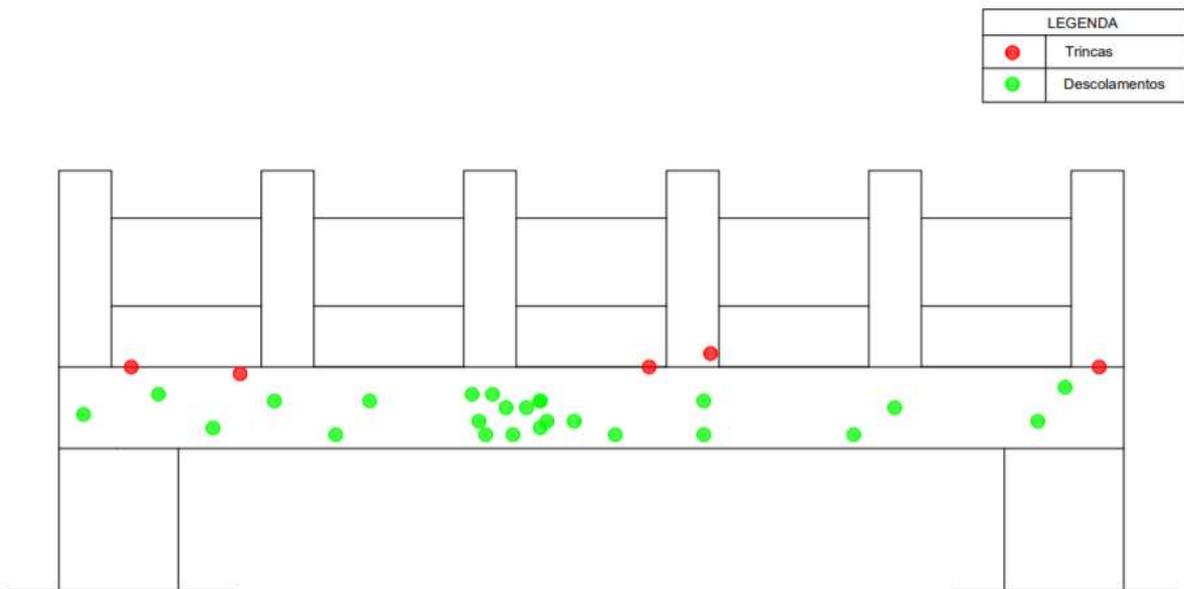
Planta Baixa da Ponte Castro Pires (Autor,2019)
